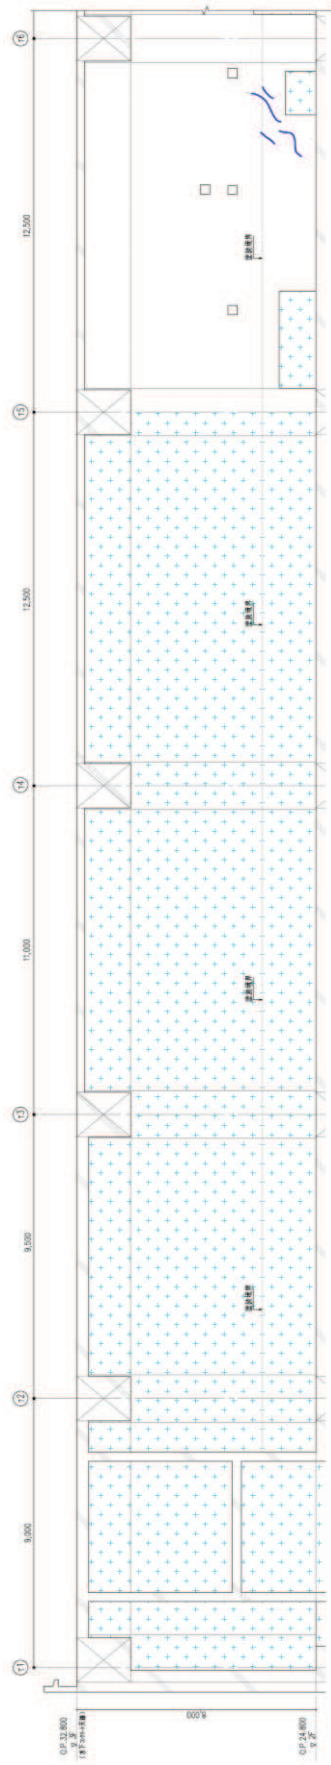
タービン建屋のひび割れ分布 耐震壁 (49) 2階 T1 通り
